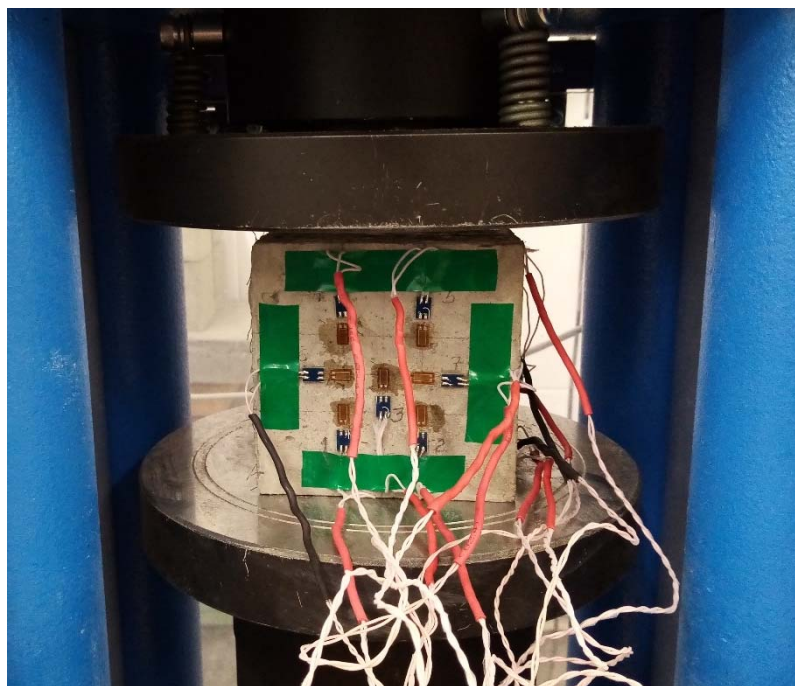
Установка образца-куба в гидравлический пресс
